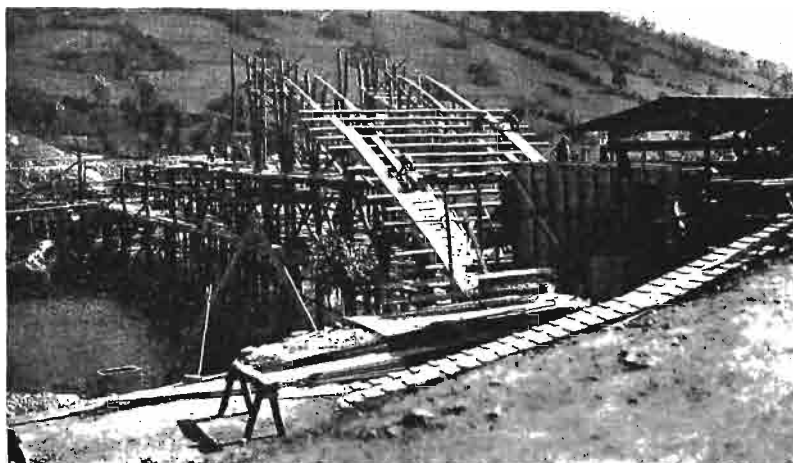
Betonowanie lewego bloku podfundamentowego.
